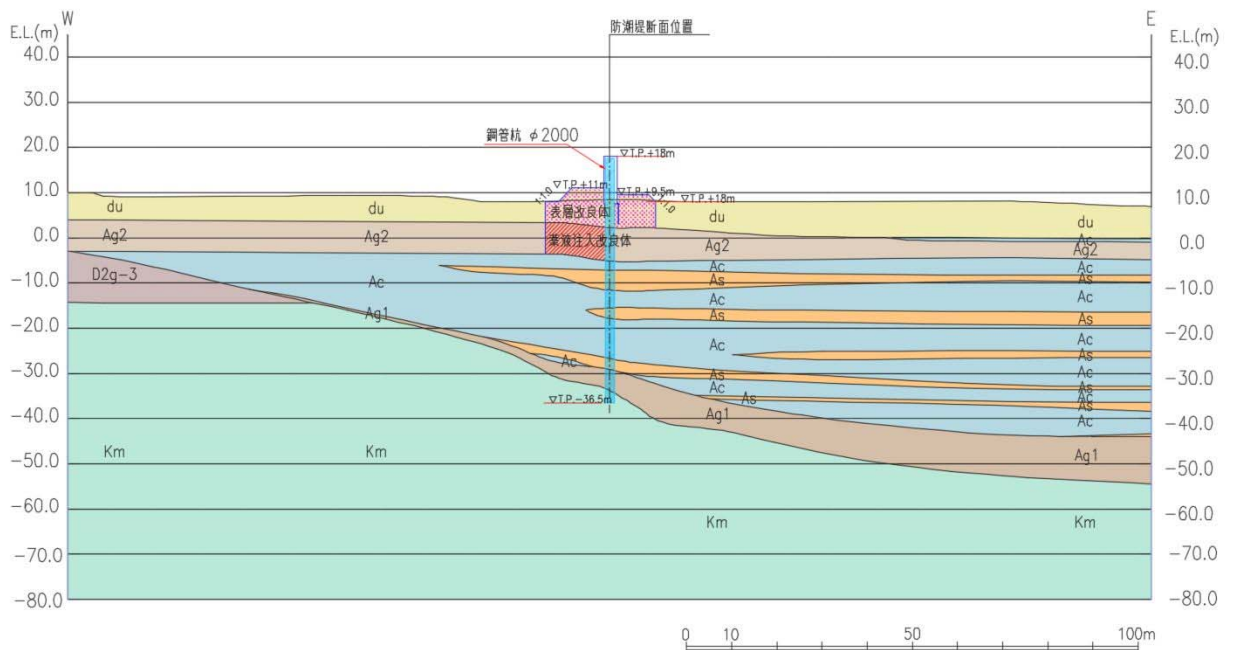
地震応答解析対象断面図 (断面⑤)
